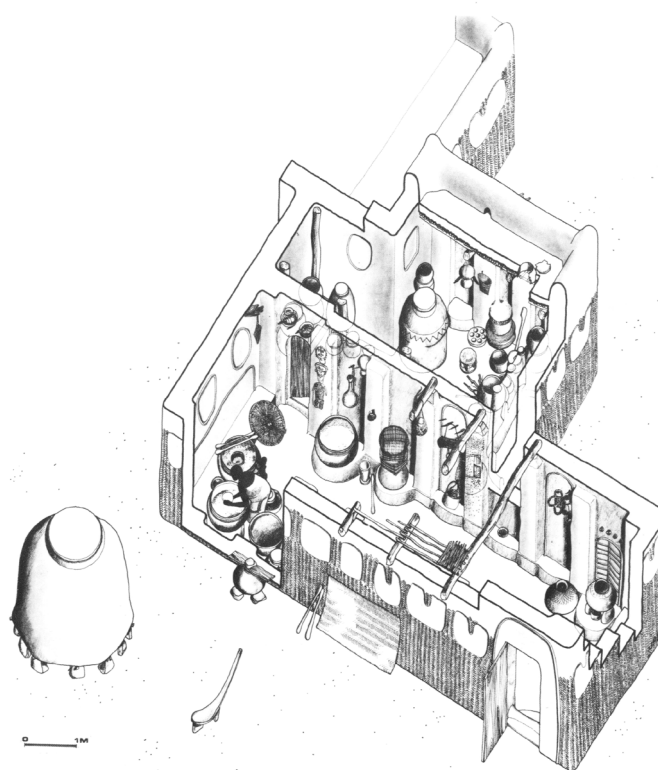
Axonometría seccionada vivienda tipo poligonal
